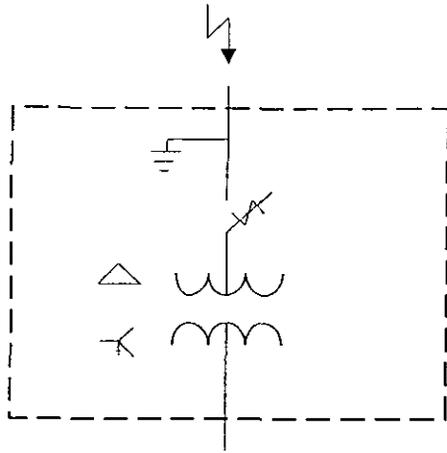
11 SUBESTACION DERIVADA TALLER DE SOLDADURA Y PAILERIA
